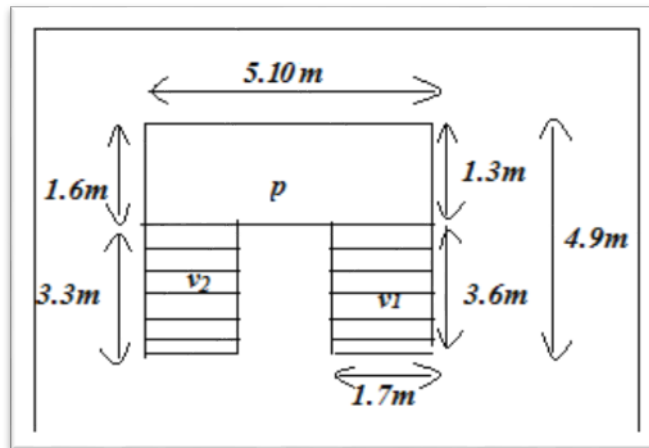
vue en plan et coupes d'escalier type 02 et 04
